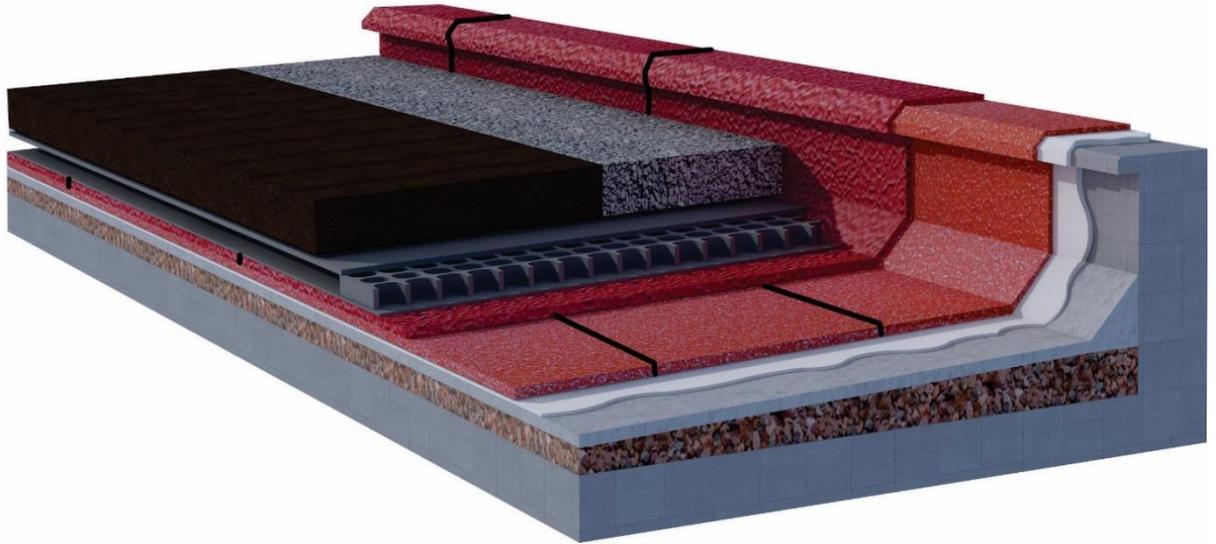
Pretel perimetral con cabezal cubierto con impermeabilizante, sobre soporte base
